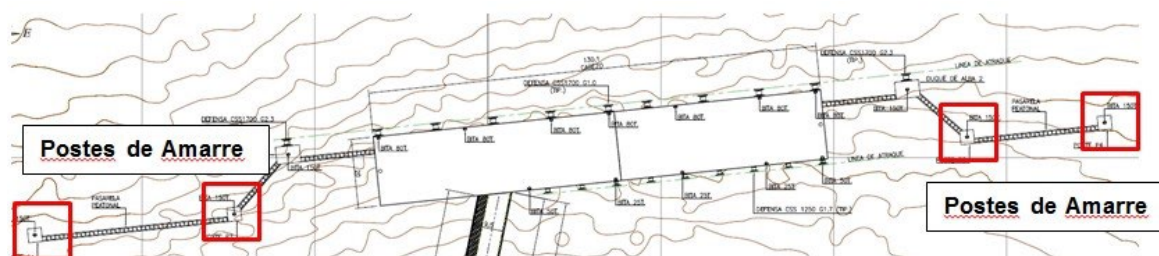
Identificación Postes de Amarre en plano de planta. Fuente: Propia.
